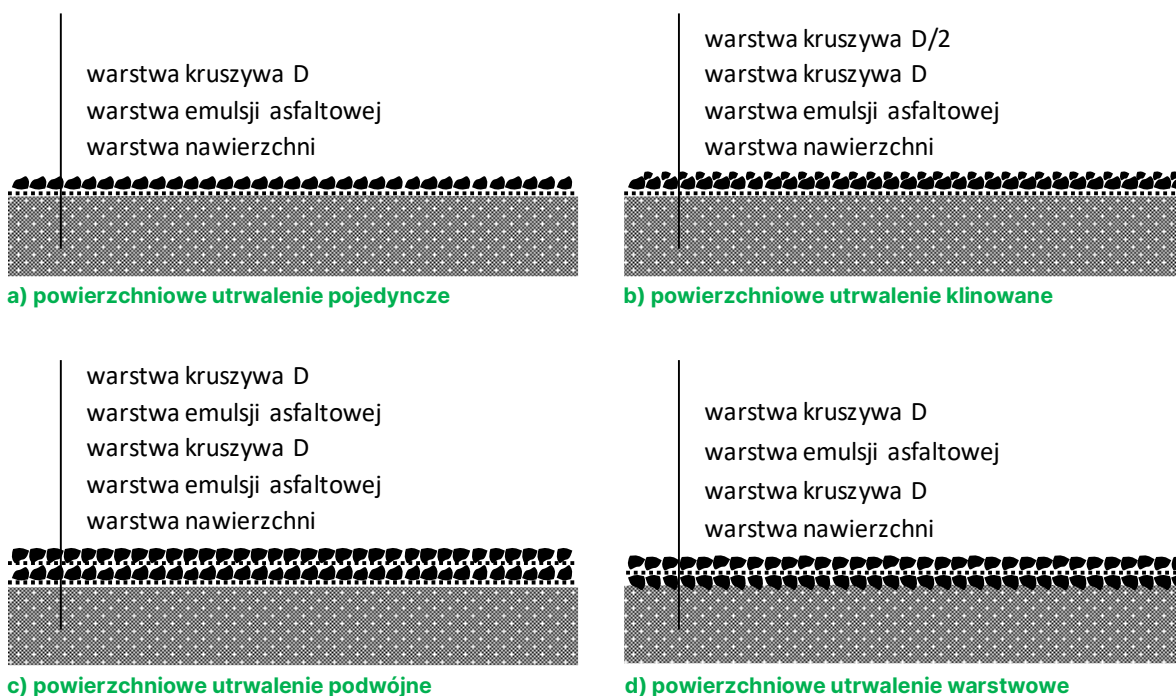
Przykład powierzchniowego utrwalenia
